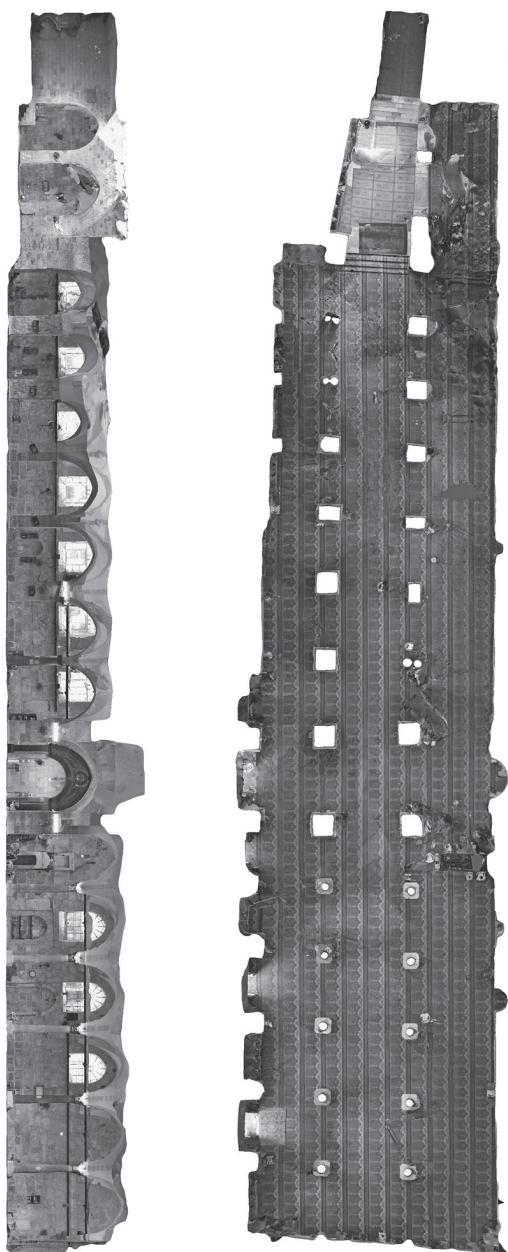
グレートモスク (ナゾルス) の平面図と南壁立面図 (オルソ画像)
